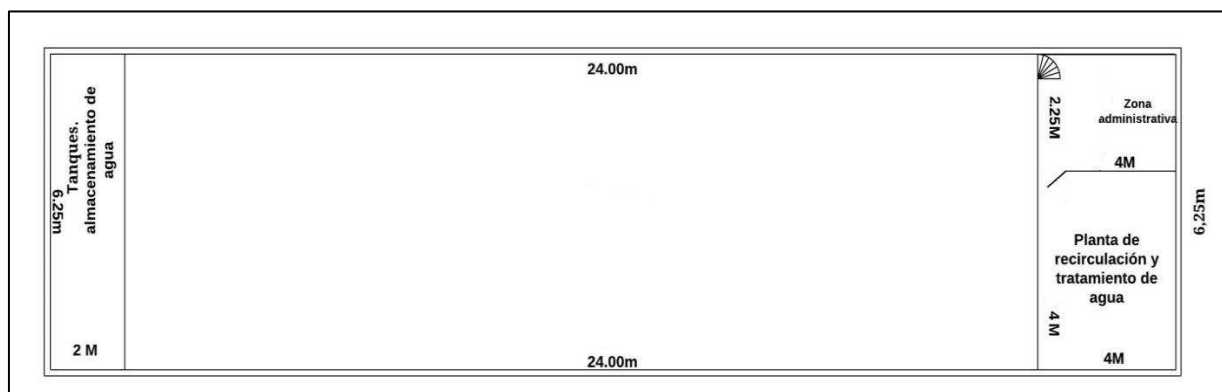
Propuesta distribución de planta segundo piso auto lavado Patio Uno. Elaboración propia
